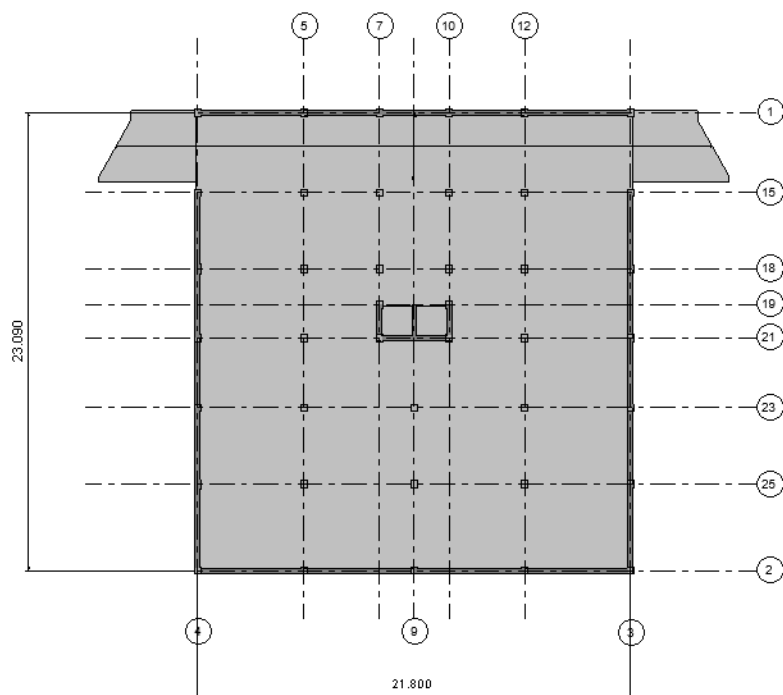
Planta estrutural da cave da solução estrutural 1 (Revit).
